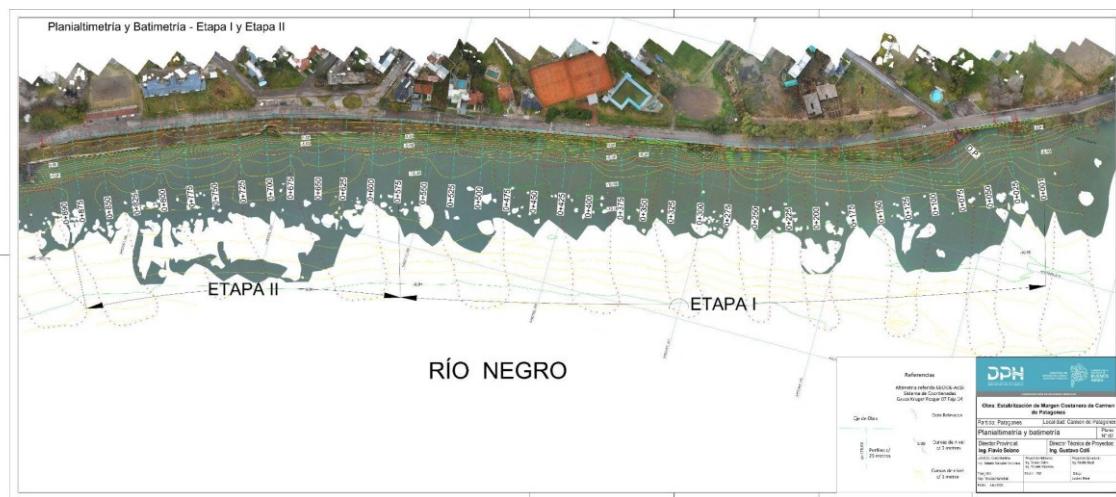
Planiáltimetría y batimetría de Etapas 1 y 2. Fuente: DPH (2025).
